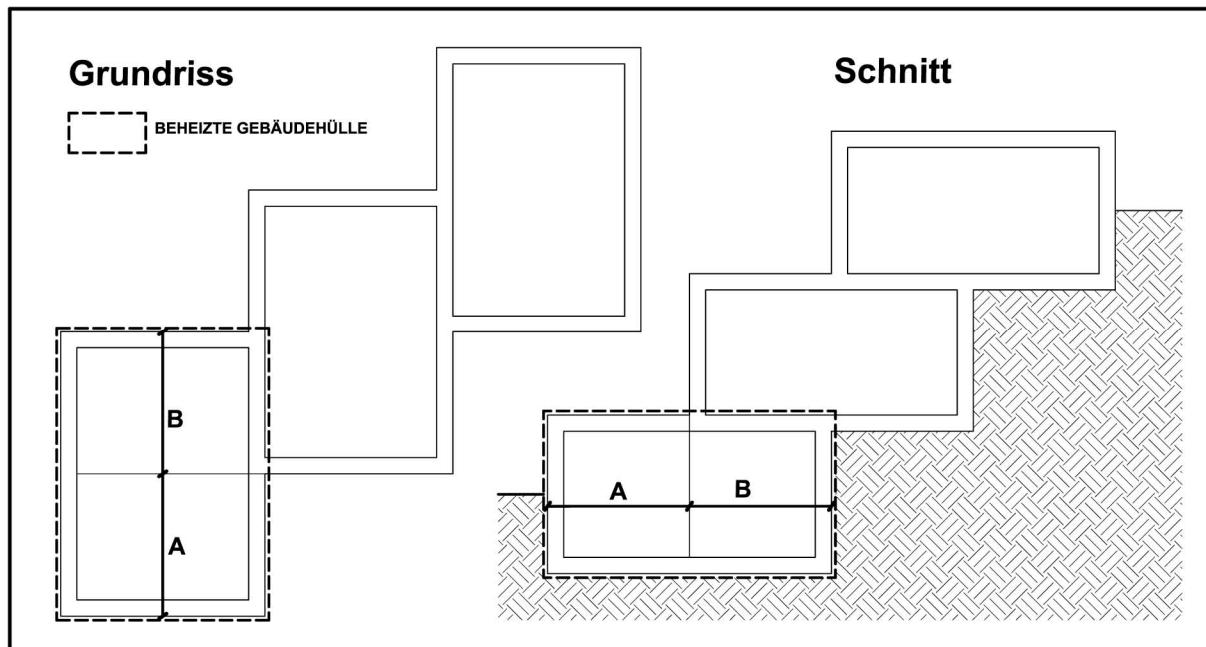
Grundriss und Schnittansicht einer Reihenhausanlage (Fall 1)
